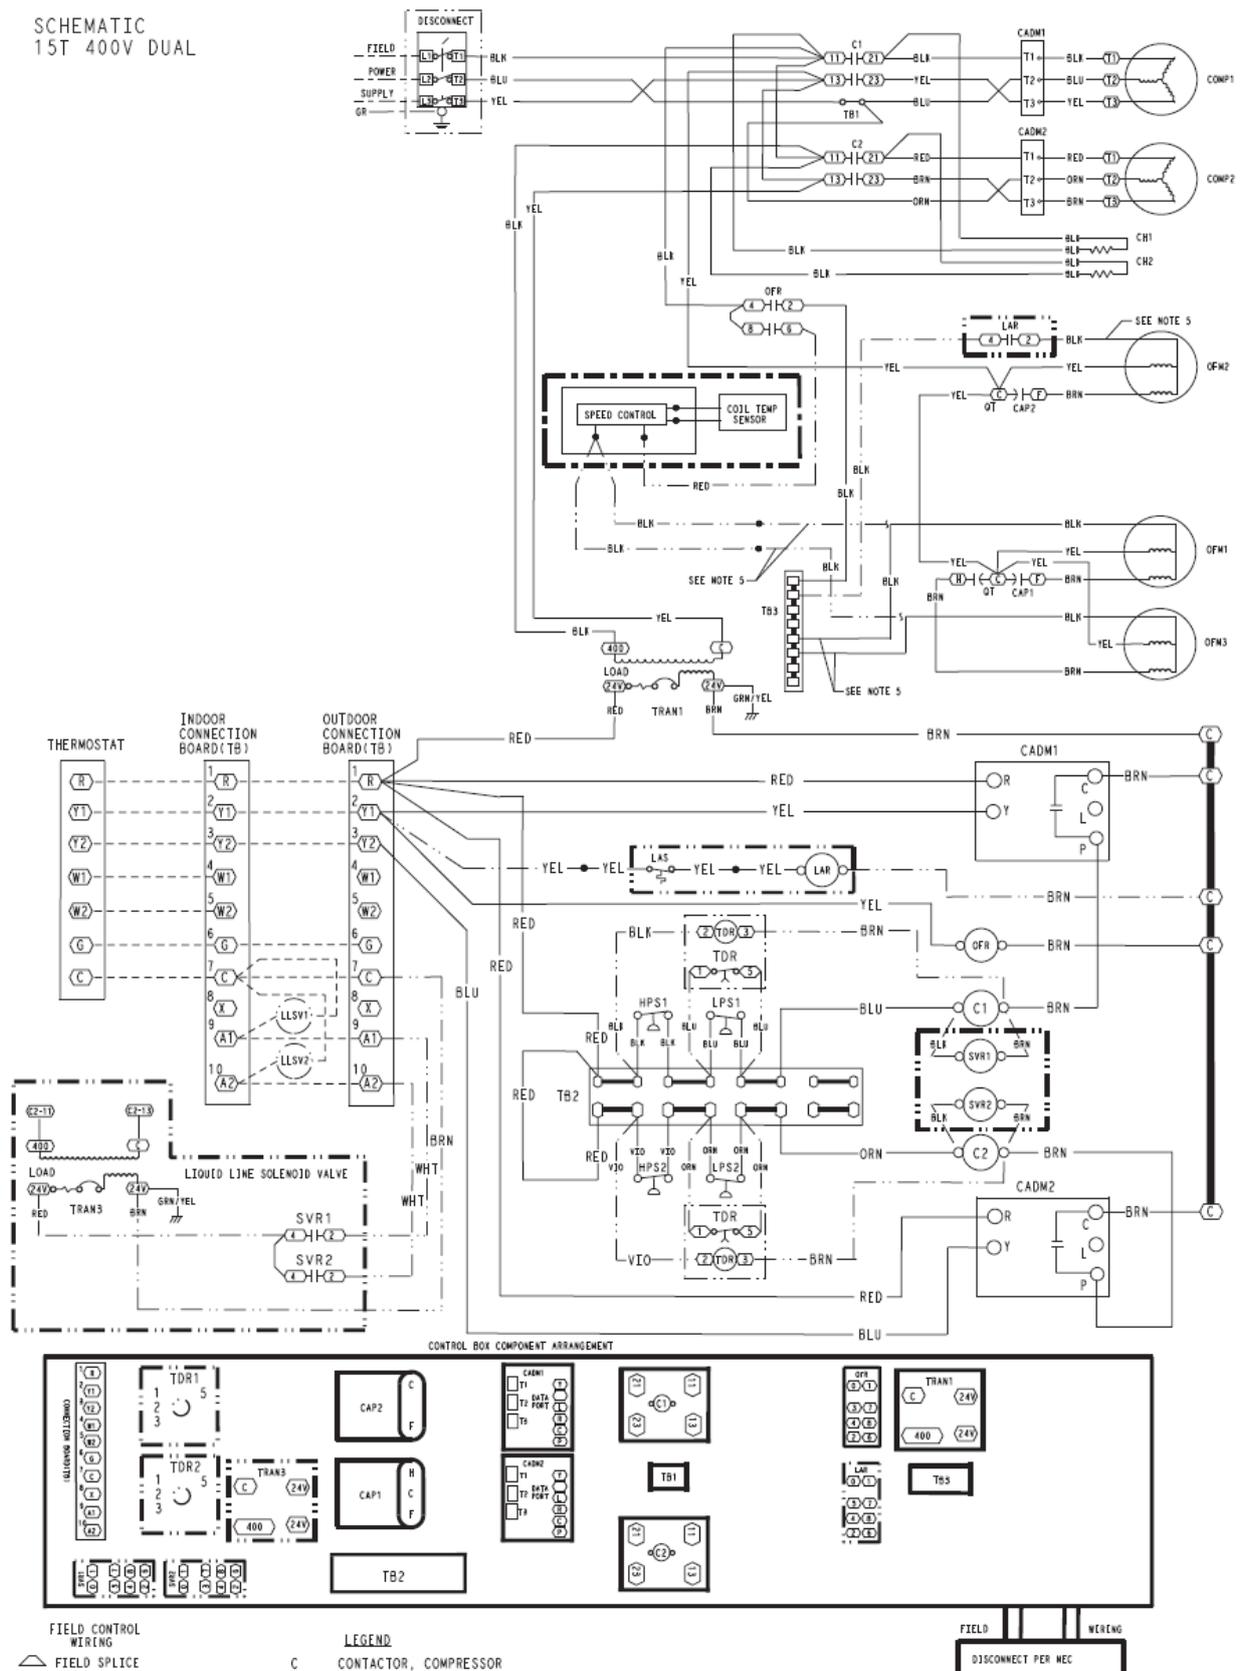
Типовая схема монтажа электропроводки блока 38AUD*16
